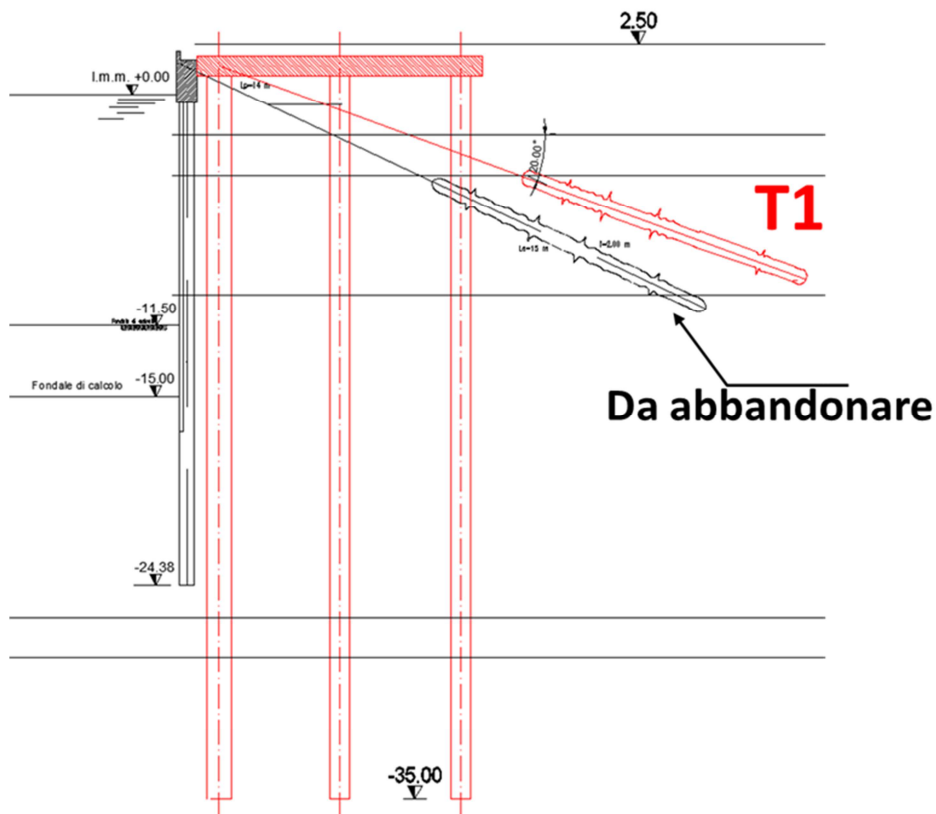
Sezione tipo intervento di adeguamento con indicazione dei tiranti di ancoraggio
